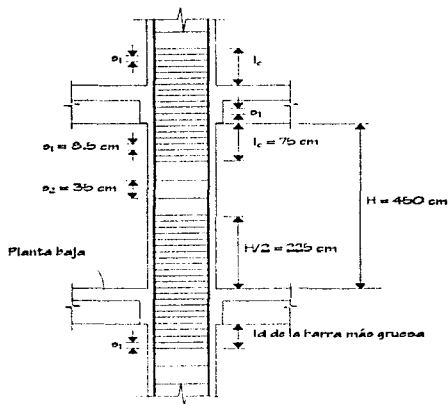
Refuerzo transversal de la columna 12 del eje 2, entrepiso PB-N1, estructura diseñada en condiciones de la zona II
